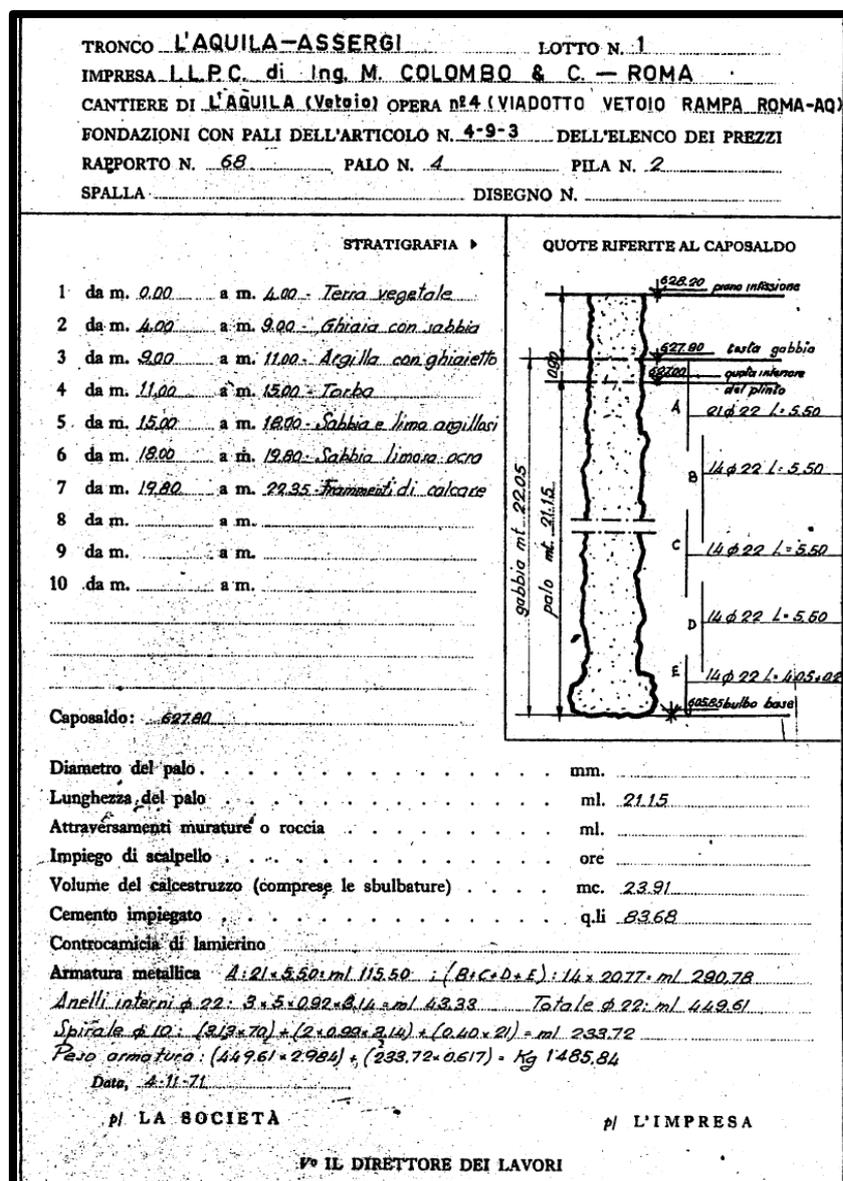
Stratigrafie dei pali di fondazione Viadotto Rampa RM-AQ Ovest.
